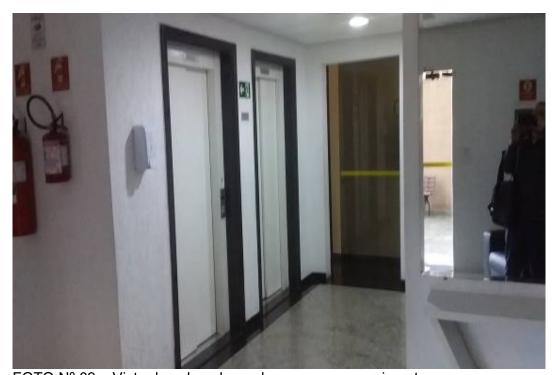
Vista dos elevadores de acesso aos pavimentos.
